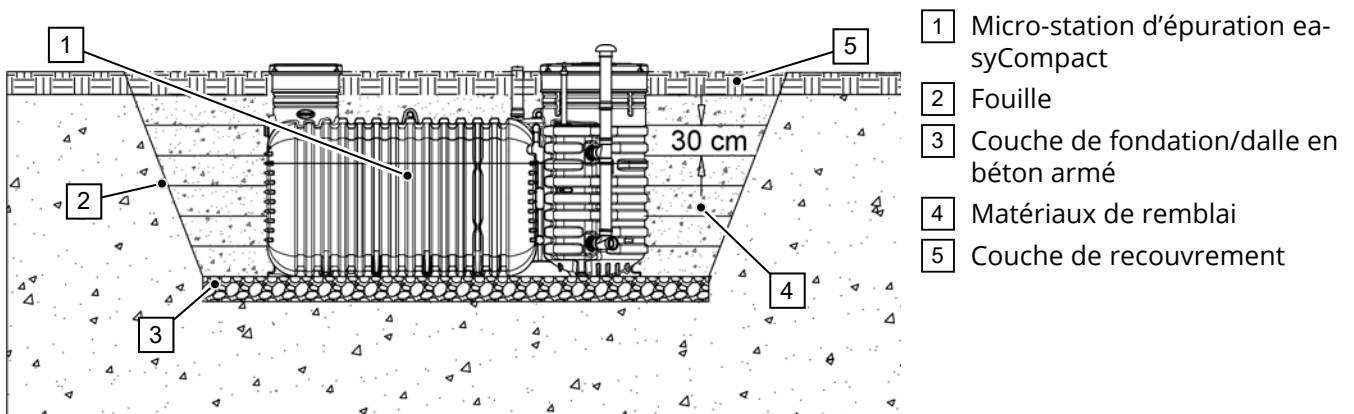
Schéma d'installation - Coupe transversale du terrain
